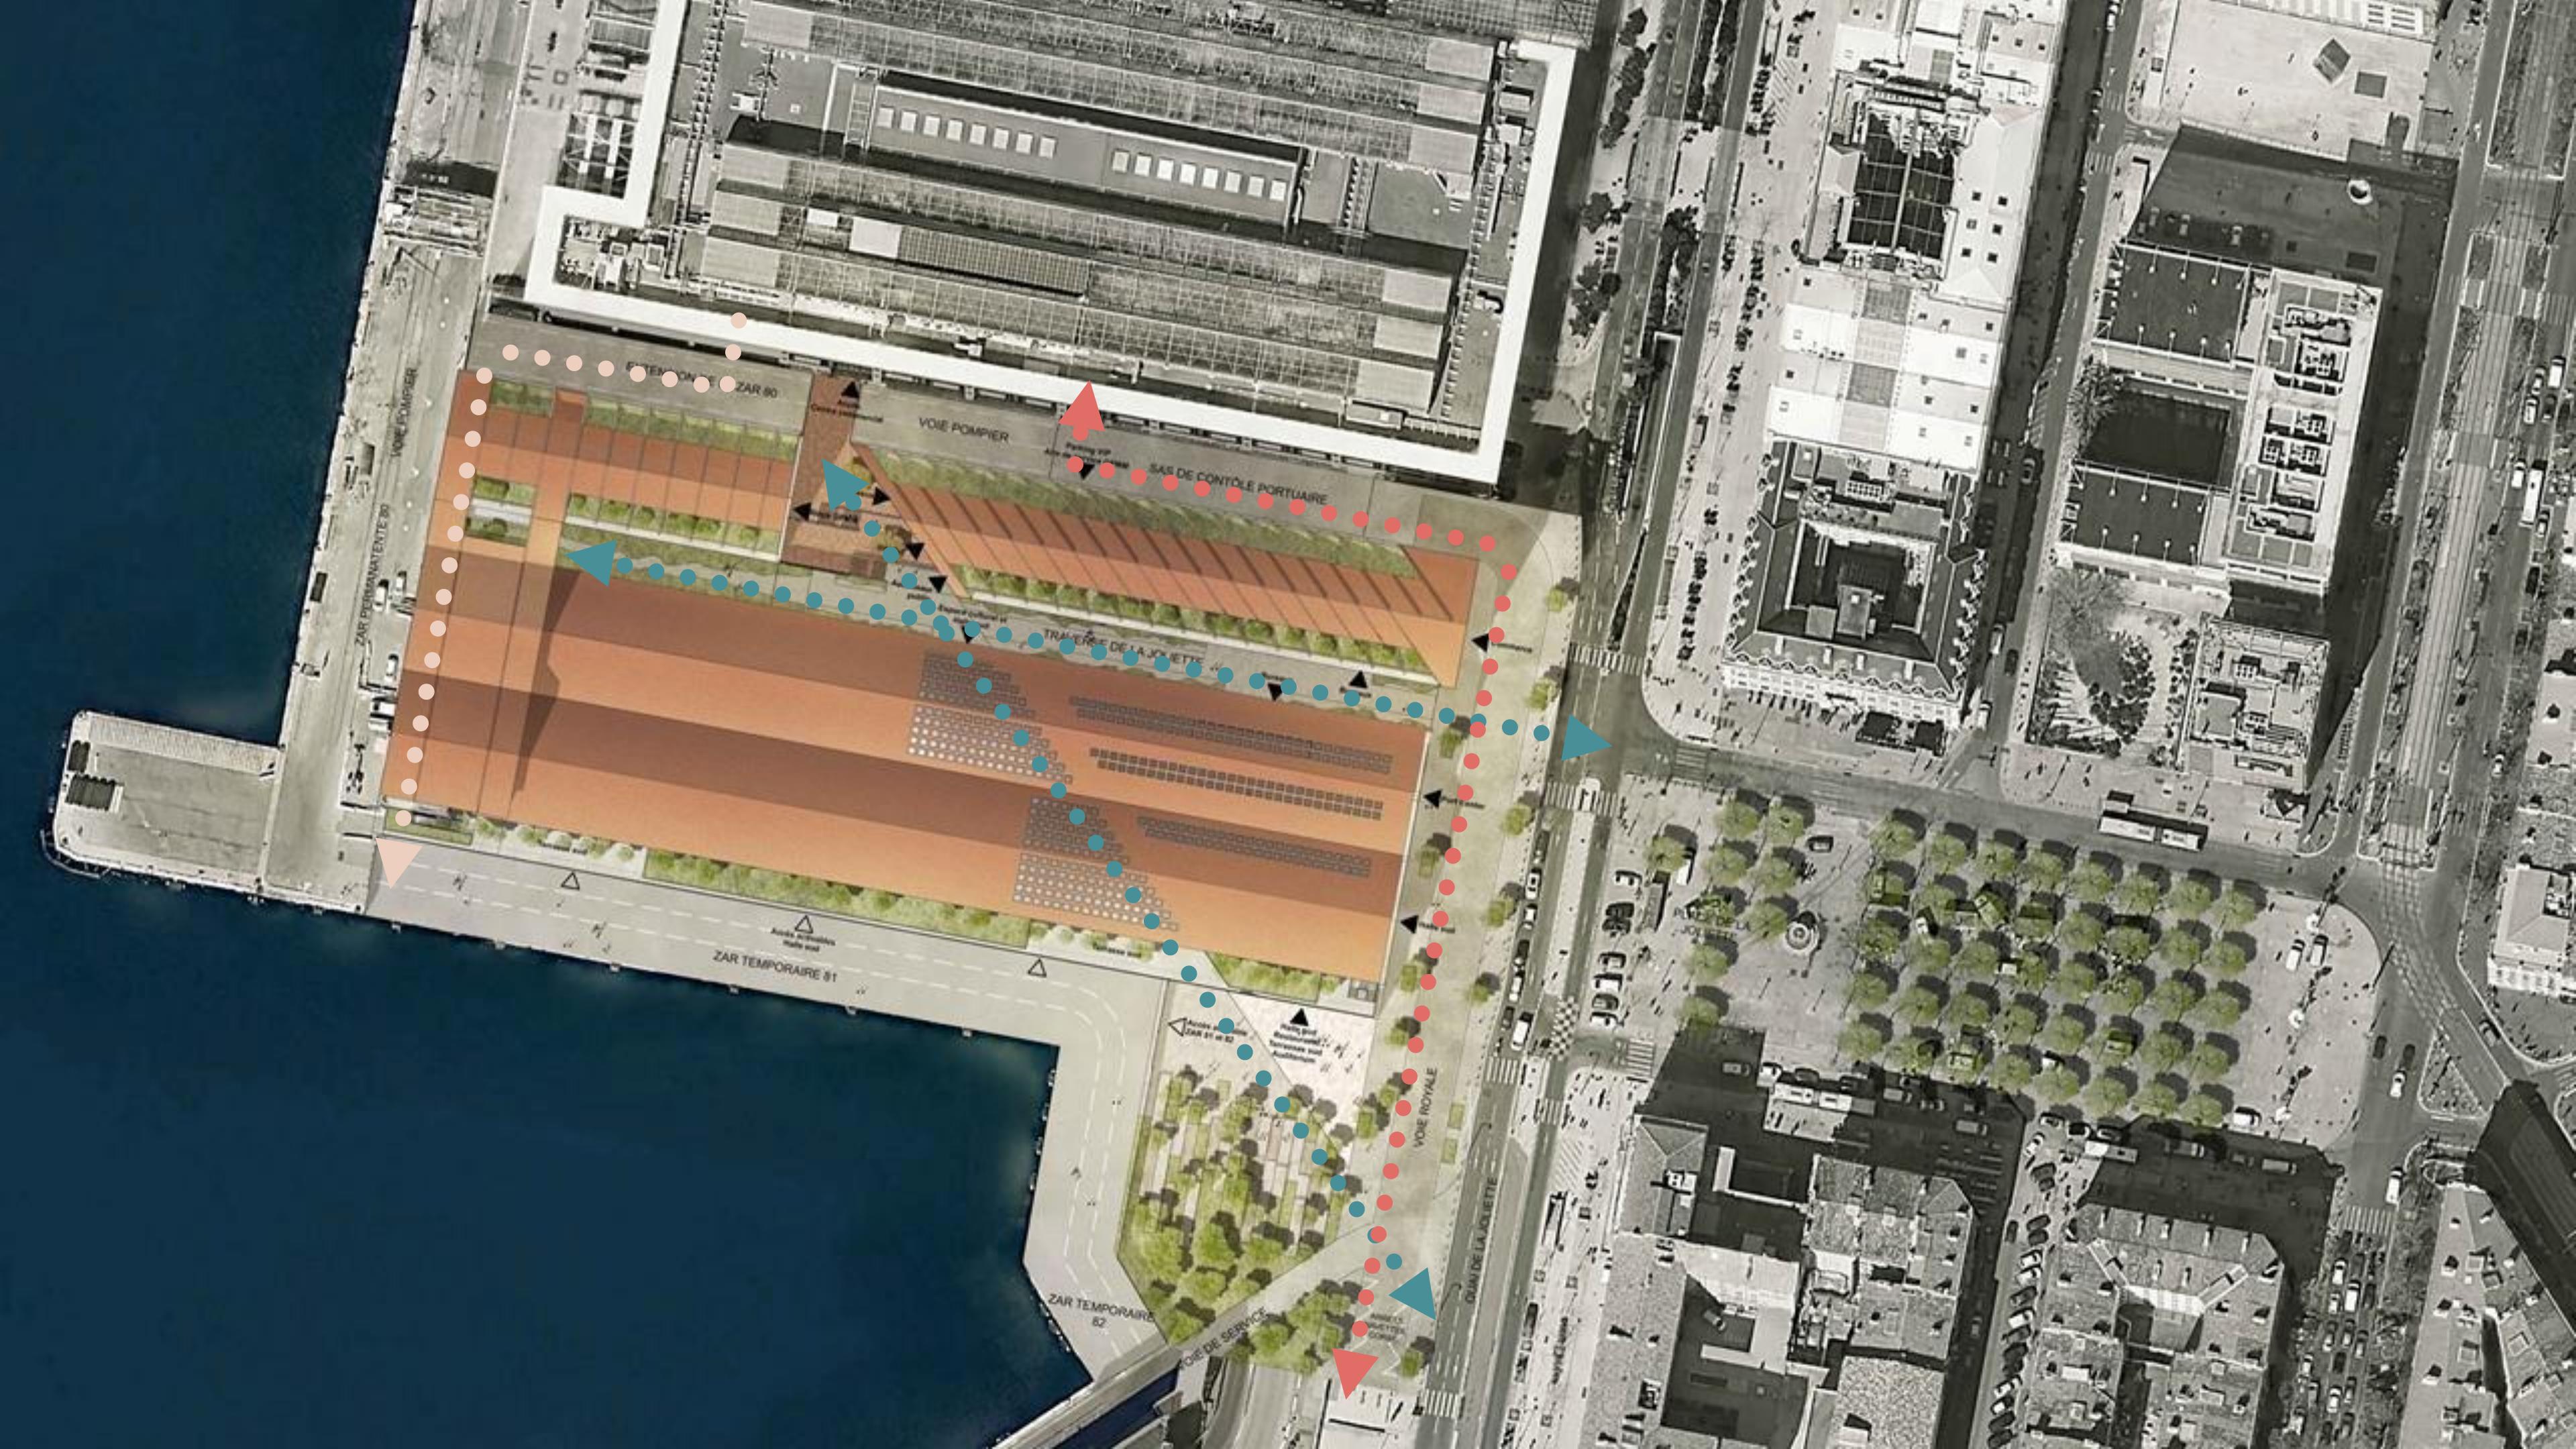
Extrait du plan d'ensemble du Bassin, Ponts et
